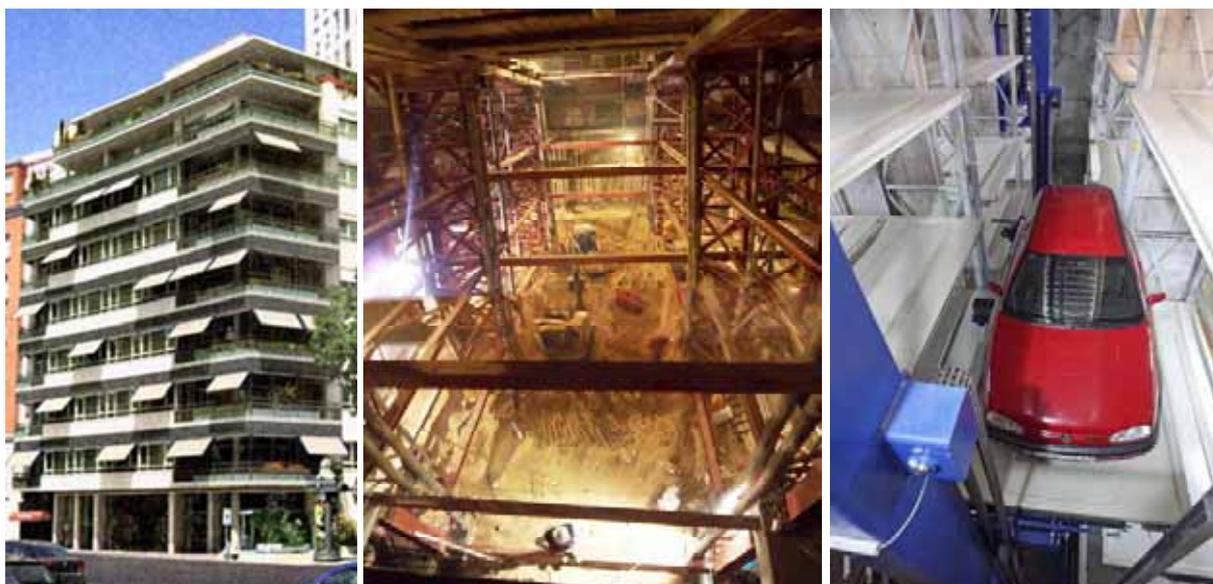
Construcción de un aparcamiento robotizado con 59 plazas bajo un edificio existente. Castellana 68, Madrid.
